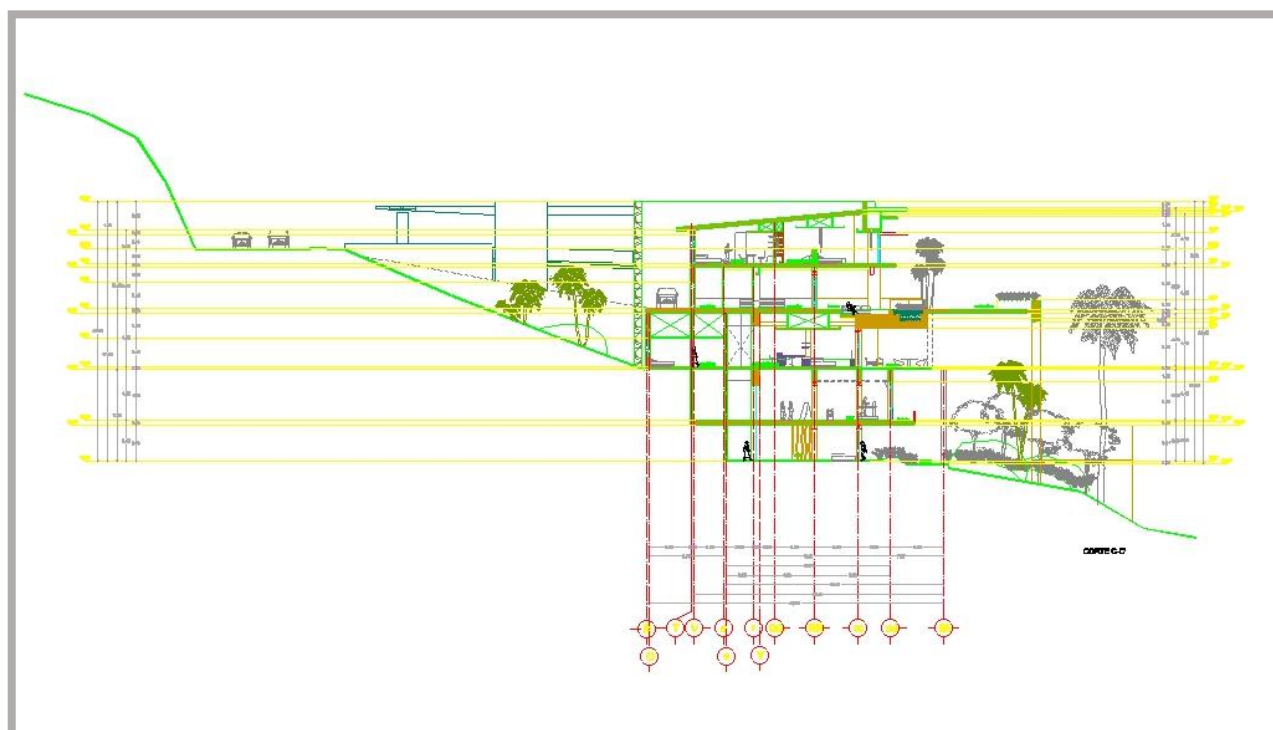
Plano arquitectónico B, perfil vertical de la obra
